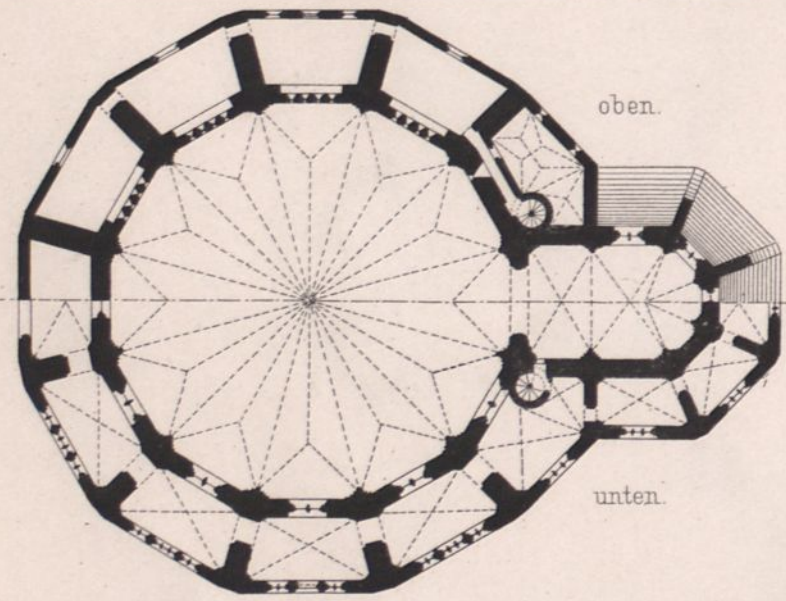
Erster Bauabschnitt. Grundriss.
